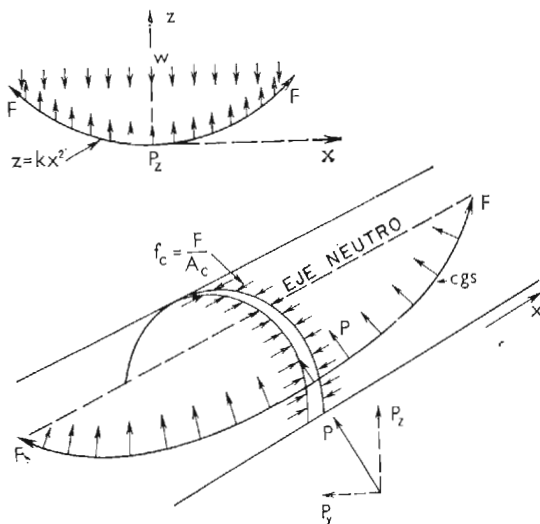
Cubierta laminar cilíndrica, bajo la acción del pretensado longitudinal, con indicación de los esfuerzos transversales originados.
